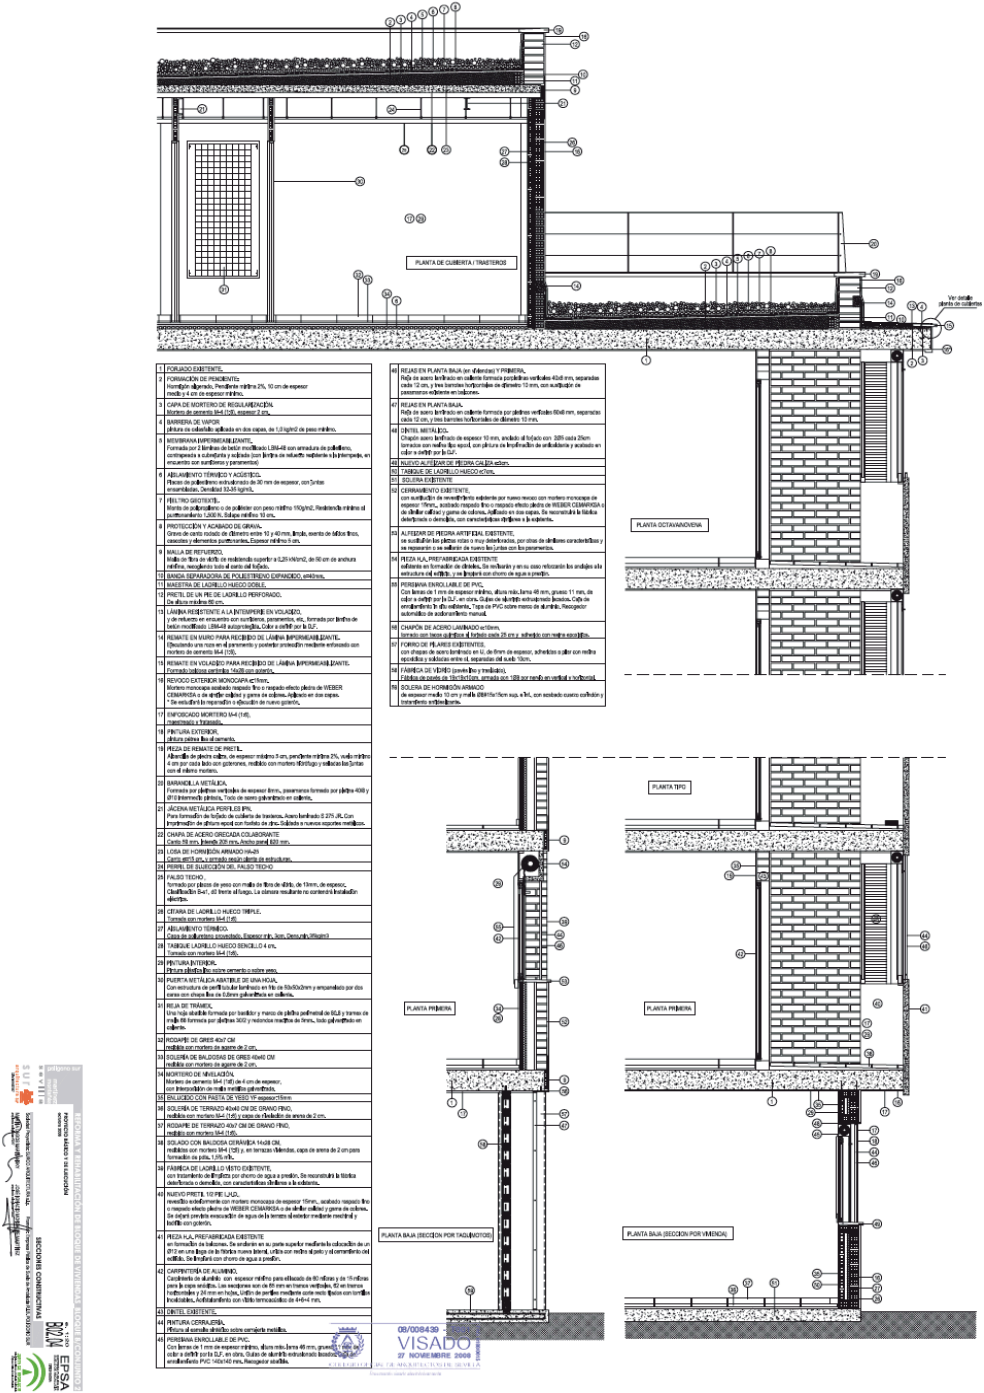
Sección constructiva del bloque 8 del conjunto 2 de la Barriada Martínez Montañés, en la que se muestra el desarrollo de la sobre-elevación de la cubierta con la finalidad de alojar una planta de trasteros. Fuente: Surco Arquitectura.
